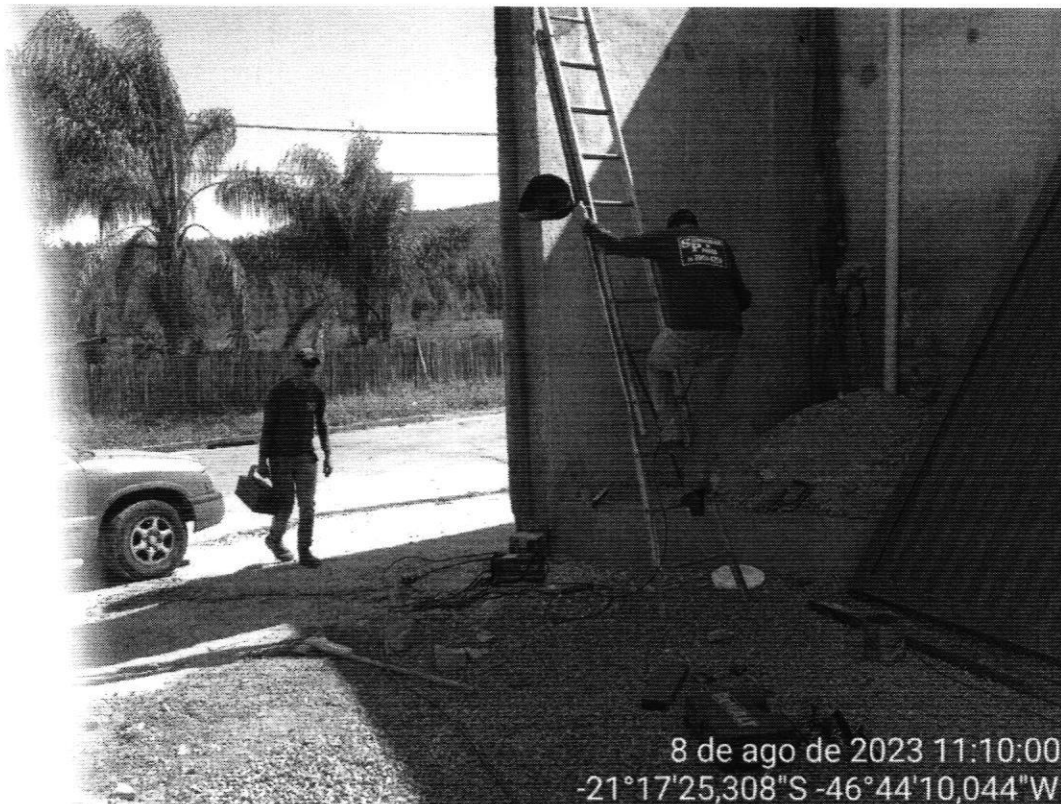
Soldadores fazendo a chumbagem do portão.
